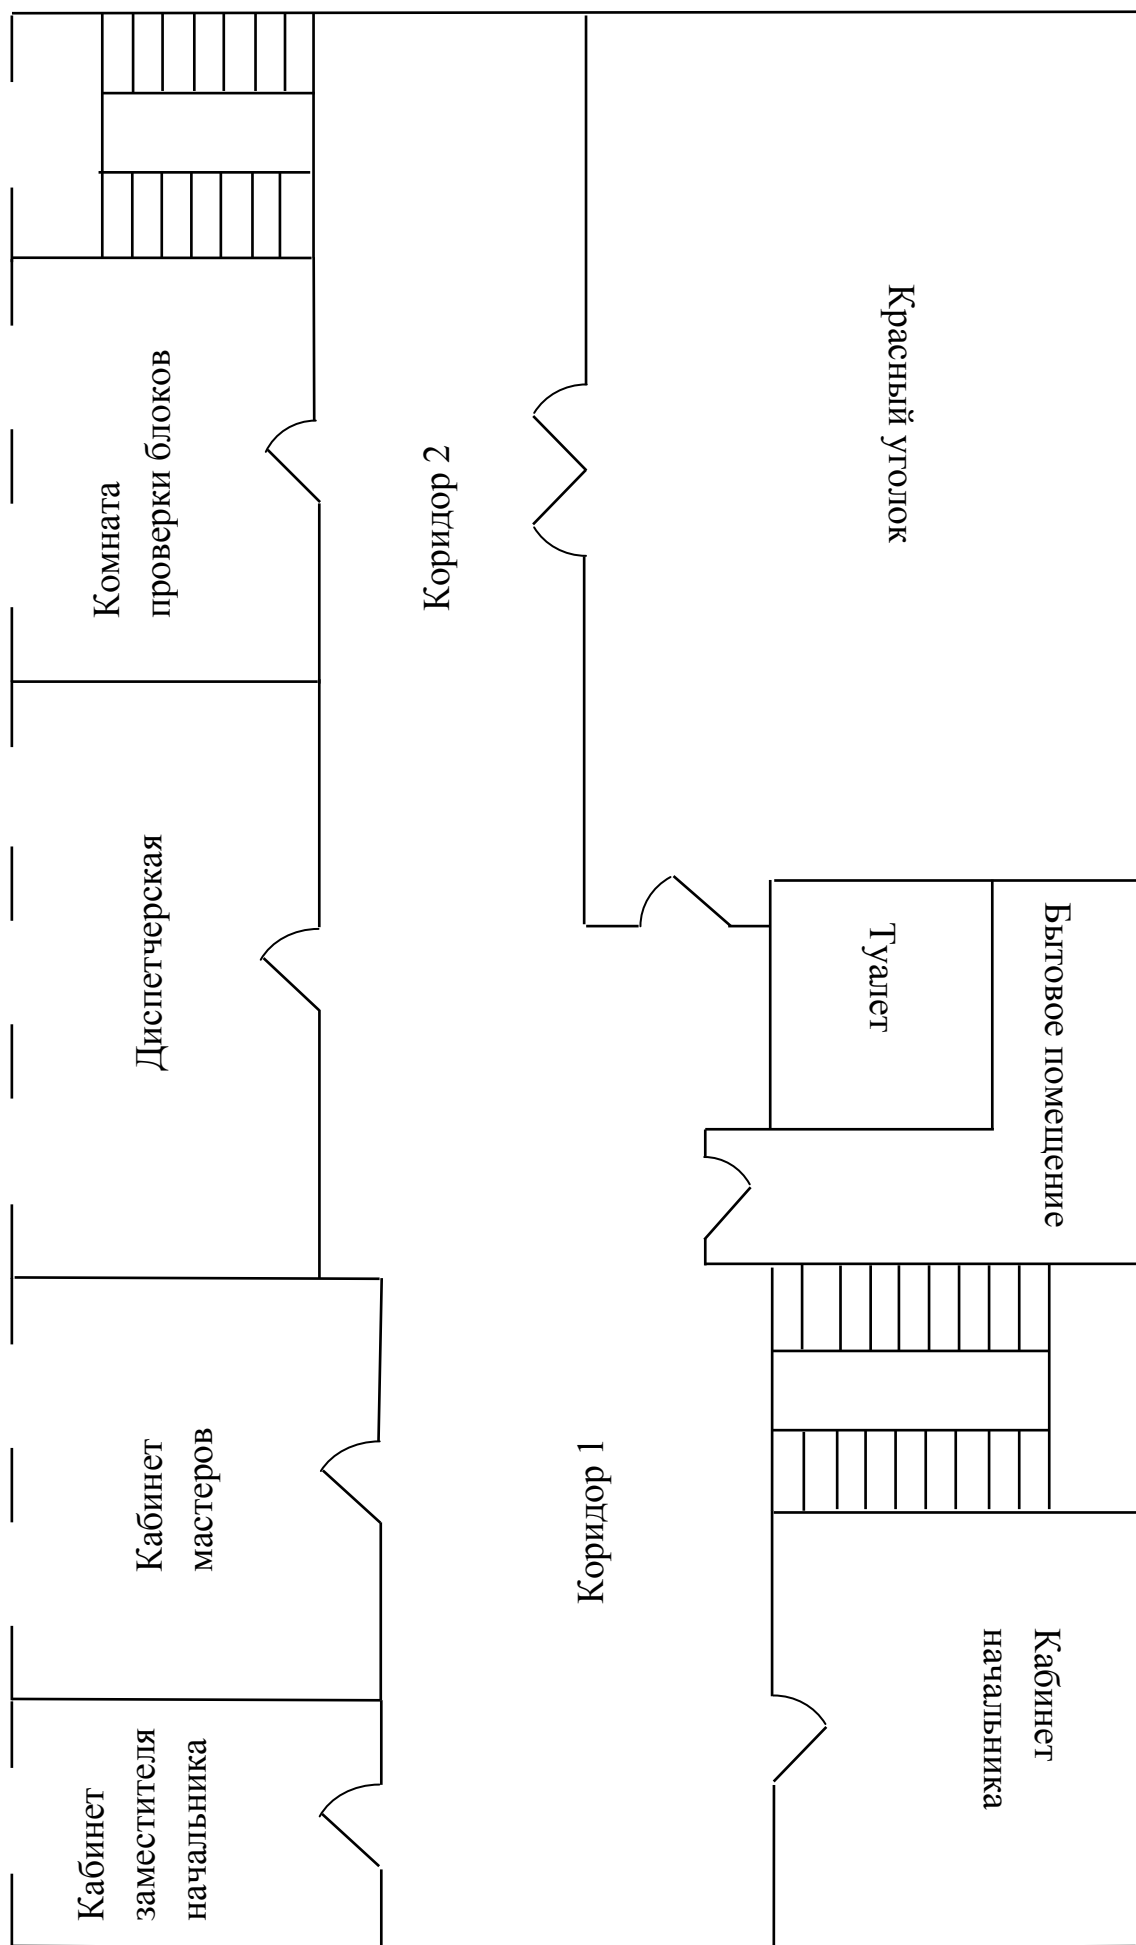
План расположения кабинетов второго этажа УПО - 1
